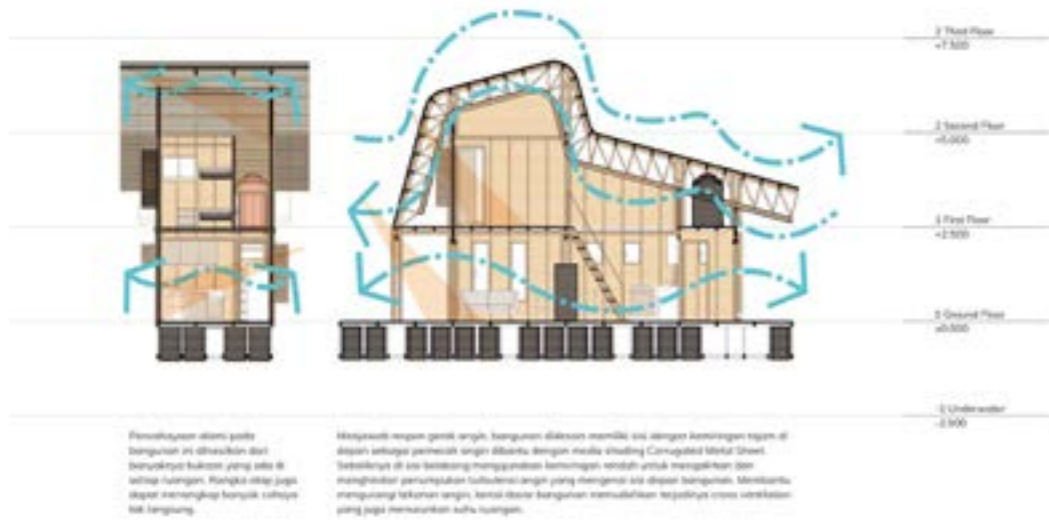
Skema Sistem Infrastruktur Bangunan.
